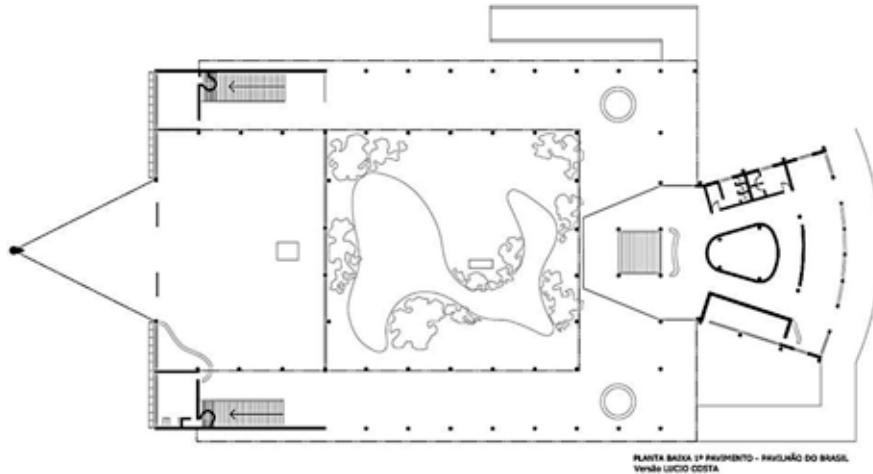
Redesenho realizado pelo acadêmico Telmo Adams e orientado pelo Prof. Alex Brino. Fonte: Grupo de Pesquisa: “Lucio Costa: Obra Completa” - dspace.uniritter.edu.br. Planta baixa do pavimento térreo.
